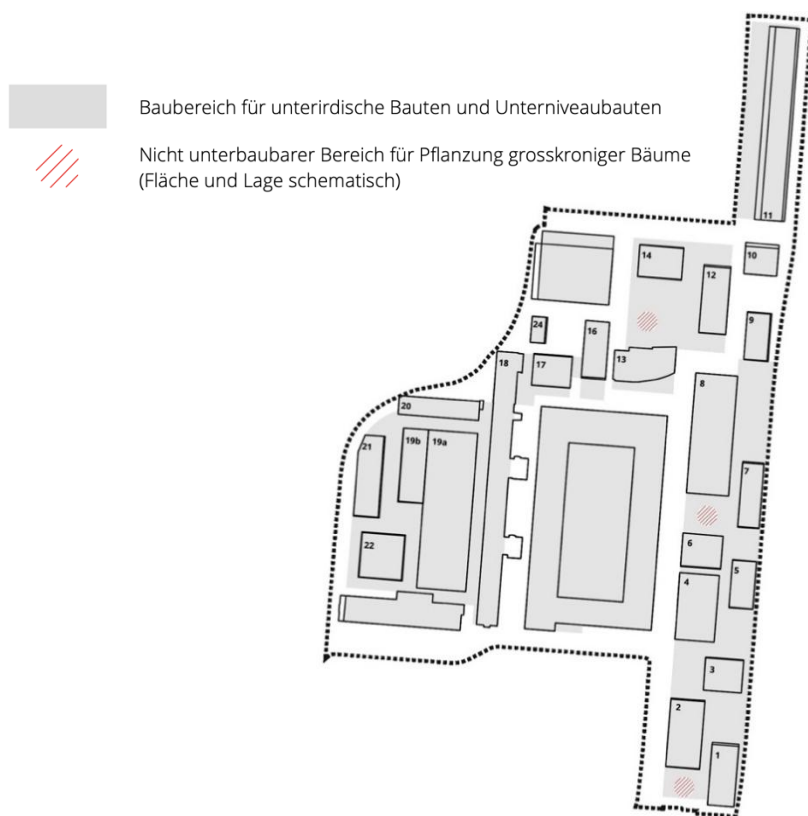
Unterbaubare und nicht unterbaubare Bereiche
